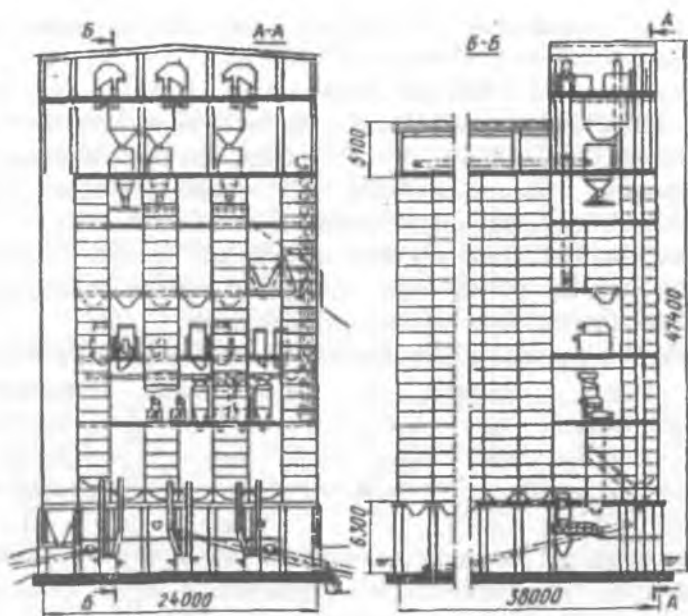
Мельничный элеватор типа МС-3Х175
